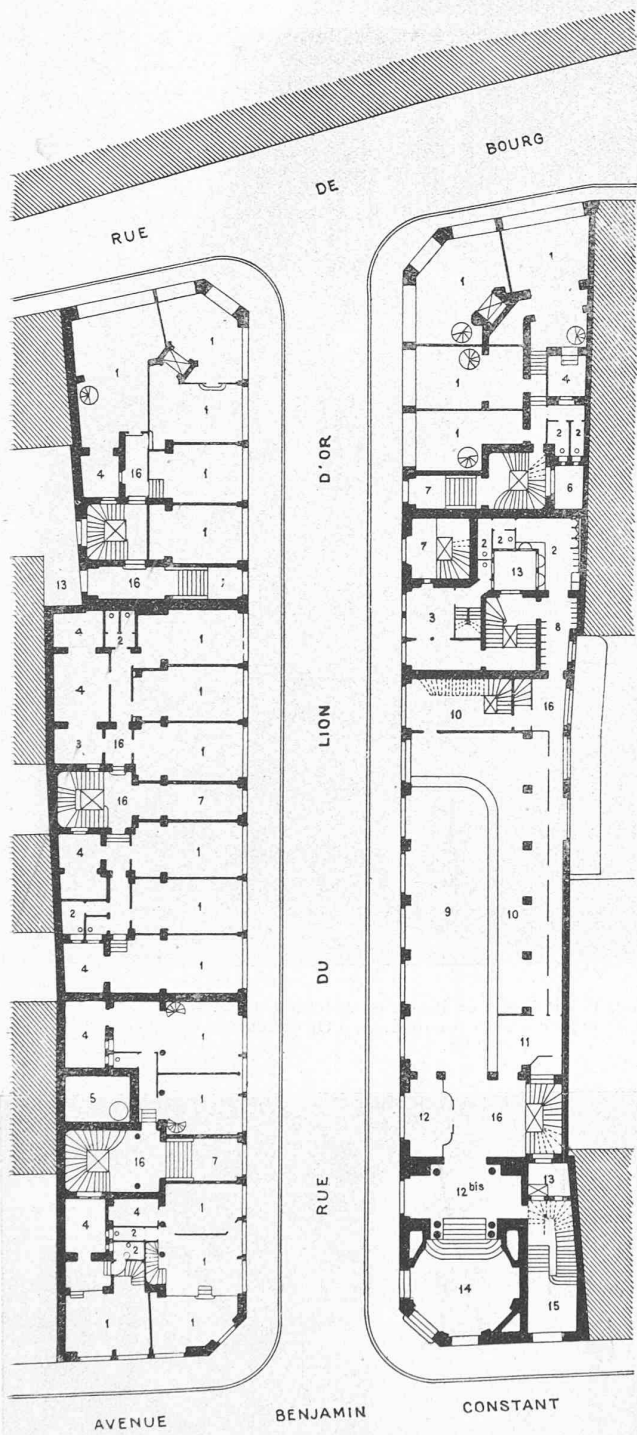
Plans des rez-de-chaussée. — 1 : 500.
